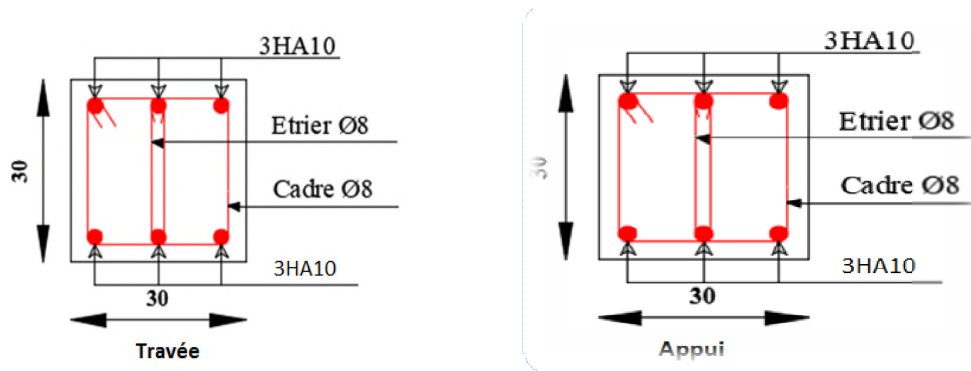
Schéma de ferrailage de la poutre de chaînage
